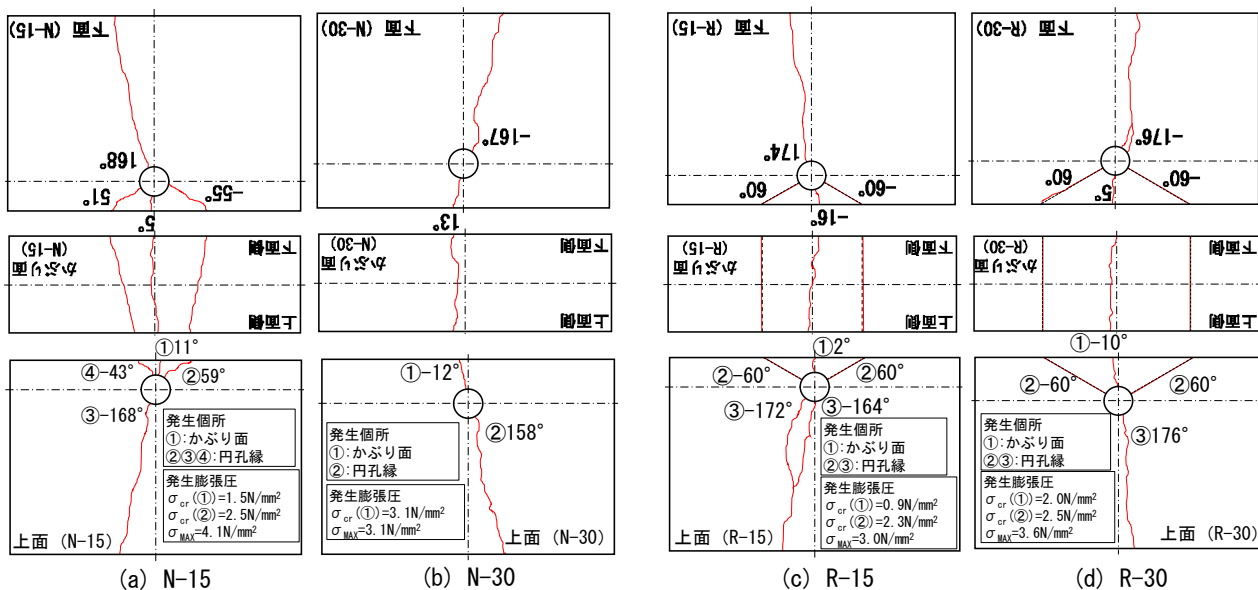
全面腐食時のひび割れおよび剥離状況 (シリーズ A)
